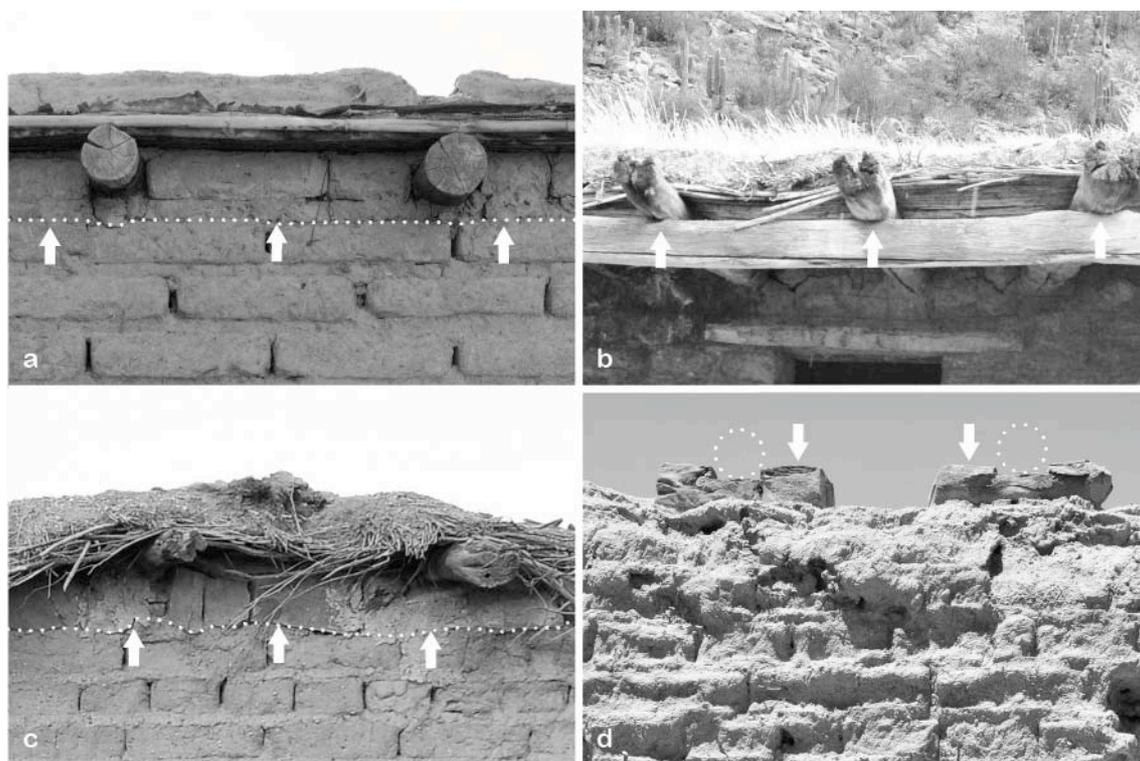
a. Fijación de cabios en el muro con elevación de una hilada, b. Apoyo de cabios en solera sin fijación, c. Apoyo de cabios sobre hilada de piedras, d. Apoyo de cabios sobre zapatas de madera. Fuente: Elaboración propia.
